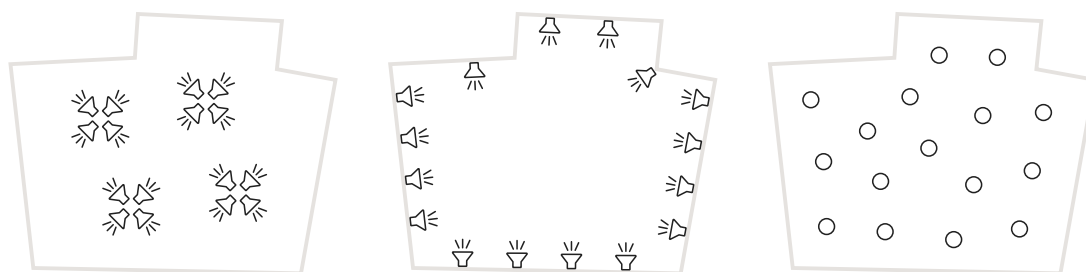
Positionnement des haut-parleurs en groupes, murale et au plafond.
